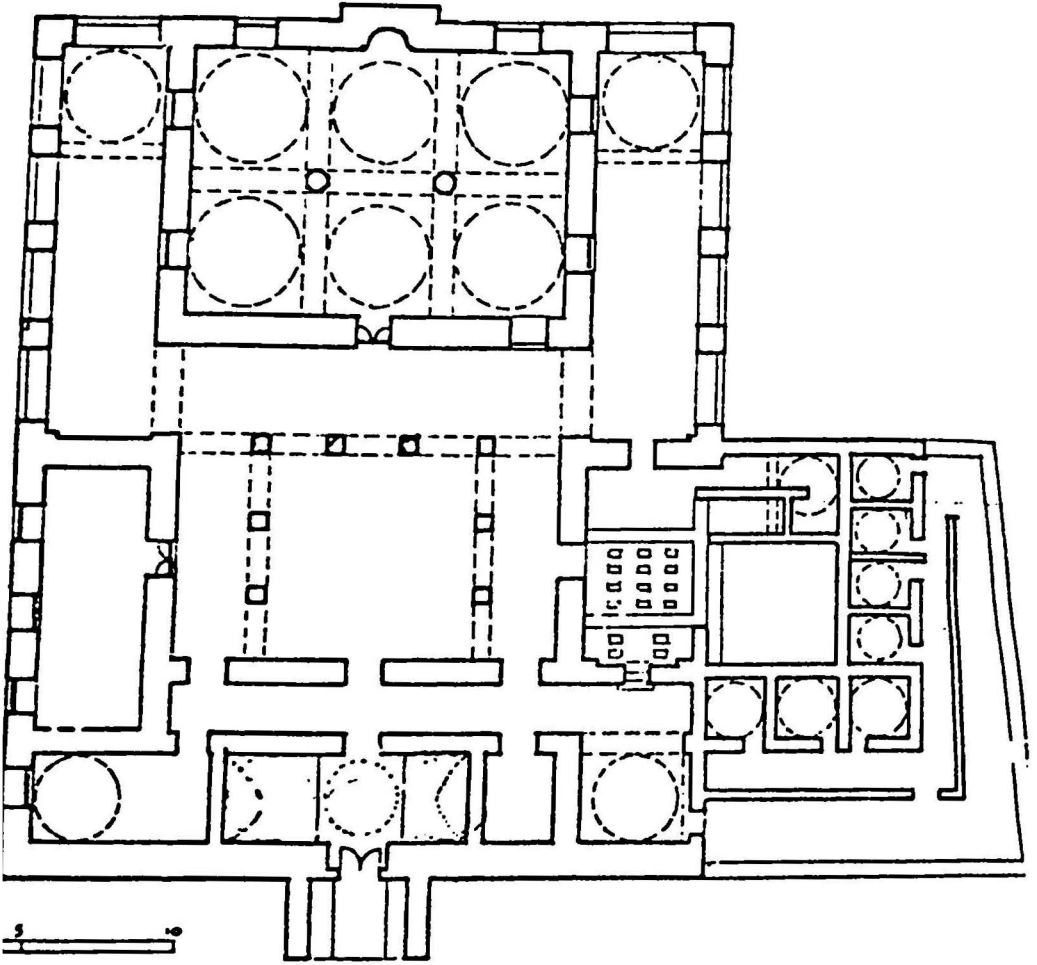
مسقط أفقي للمدرسة الأشرفية - تمز الطابق الأول - الطابق الثاني
